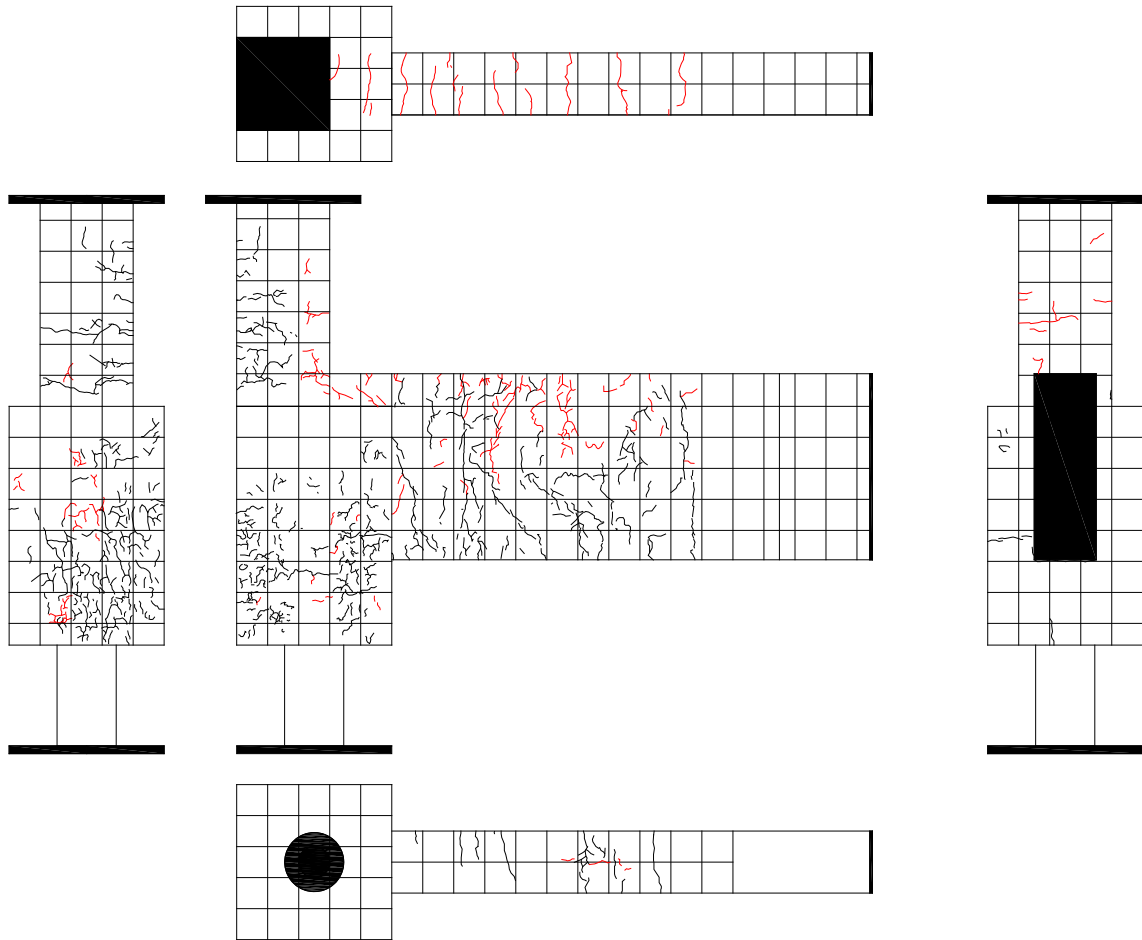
試験体 C-3 ひび割れ状況 (1Cycle)
